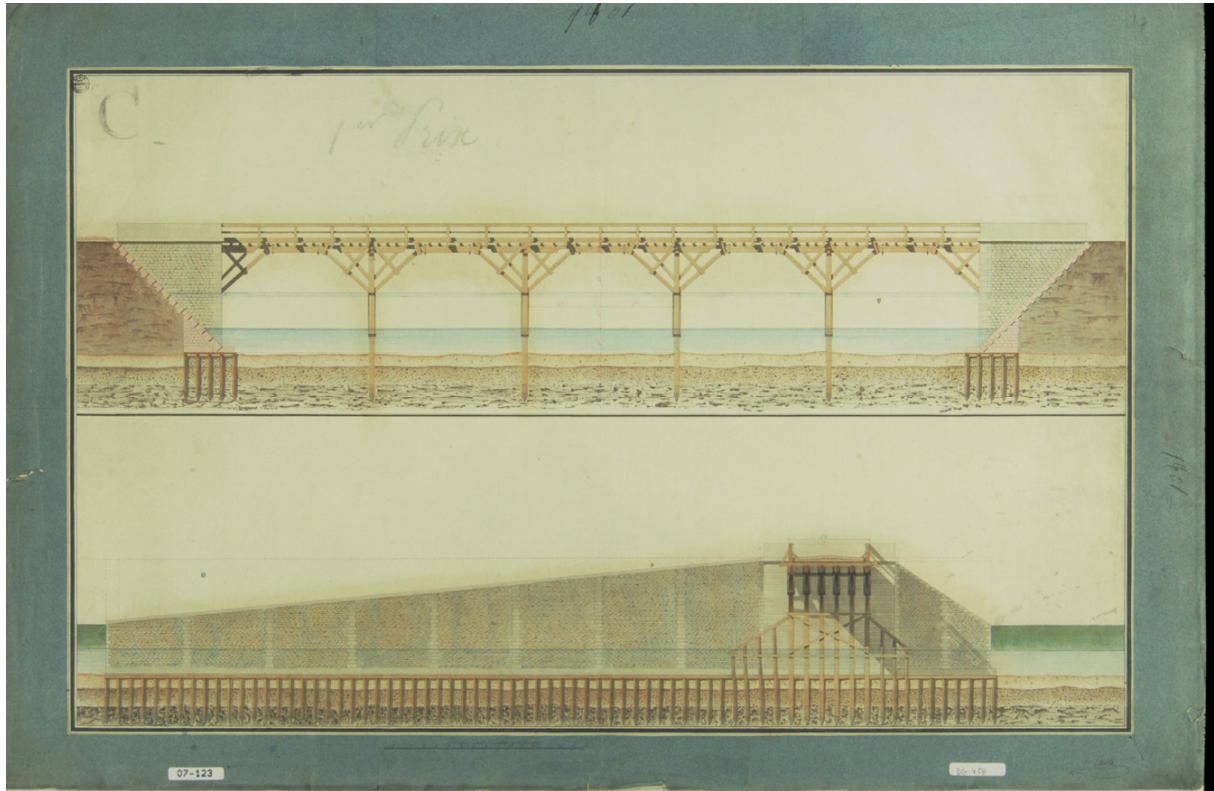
Ponte in legno: prospetto e sezione. © Collection École Nationale des Ponts et Chaussées. DG 458
